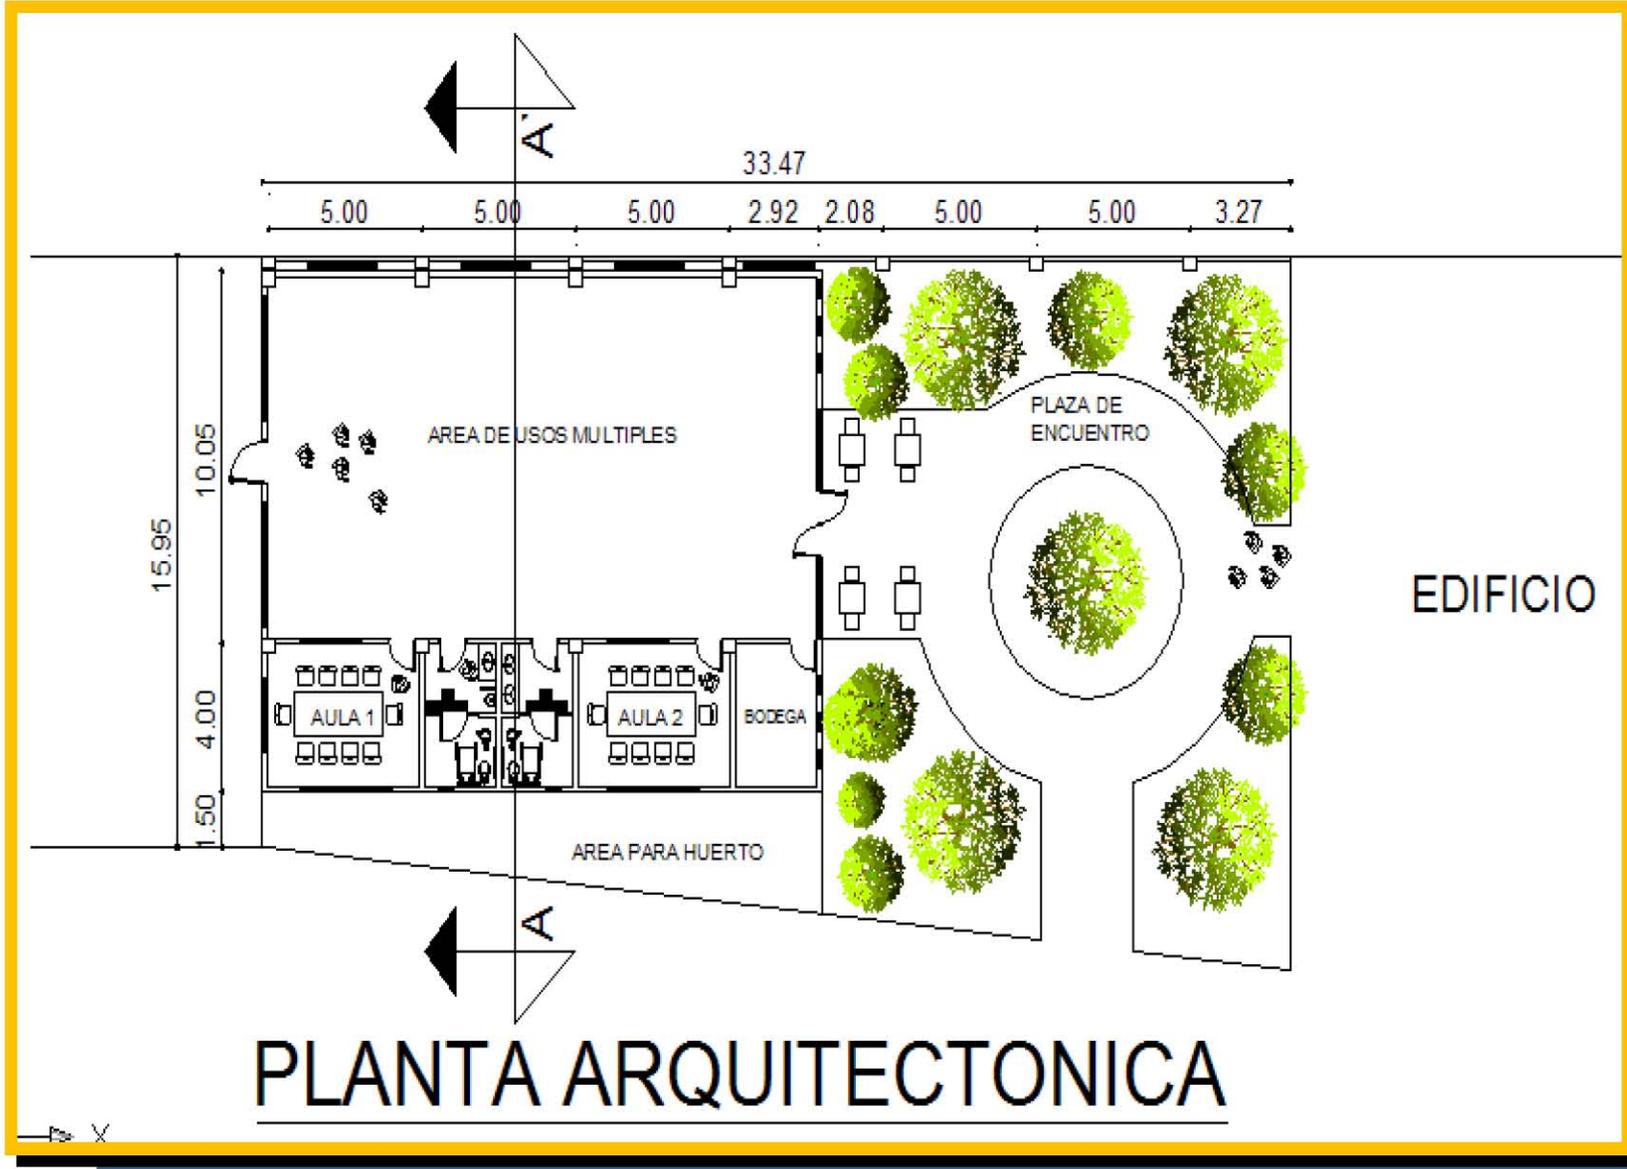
(planta arquitectónica-u.h. Emiliano Zapata)
